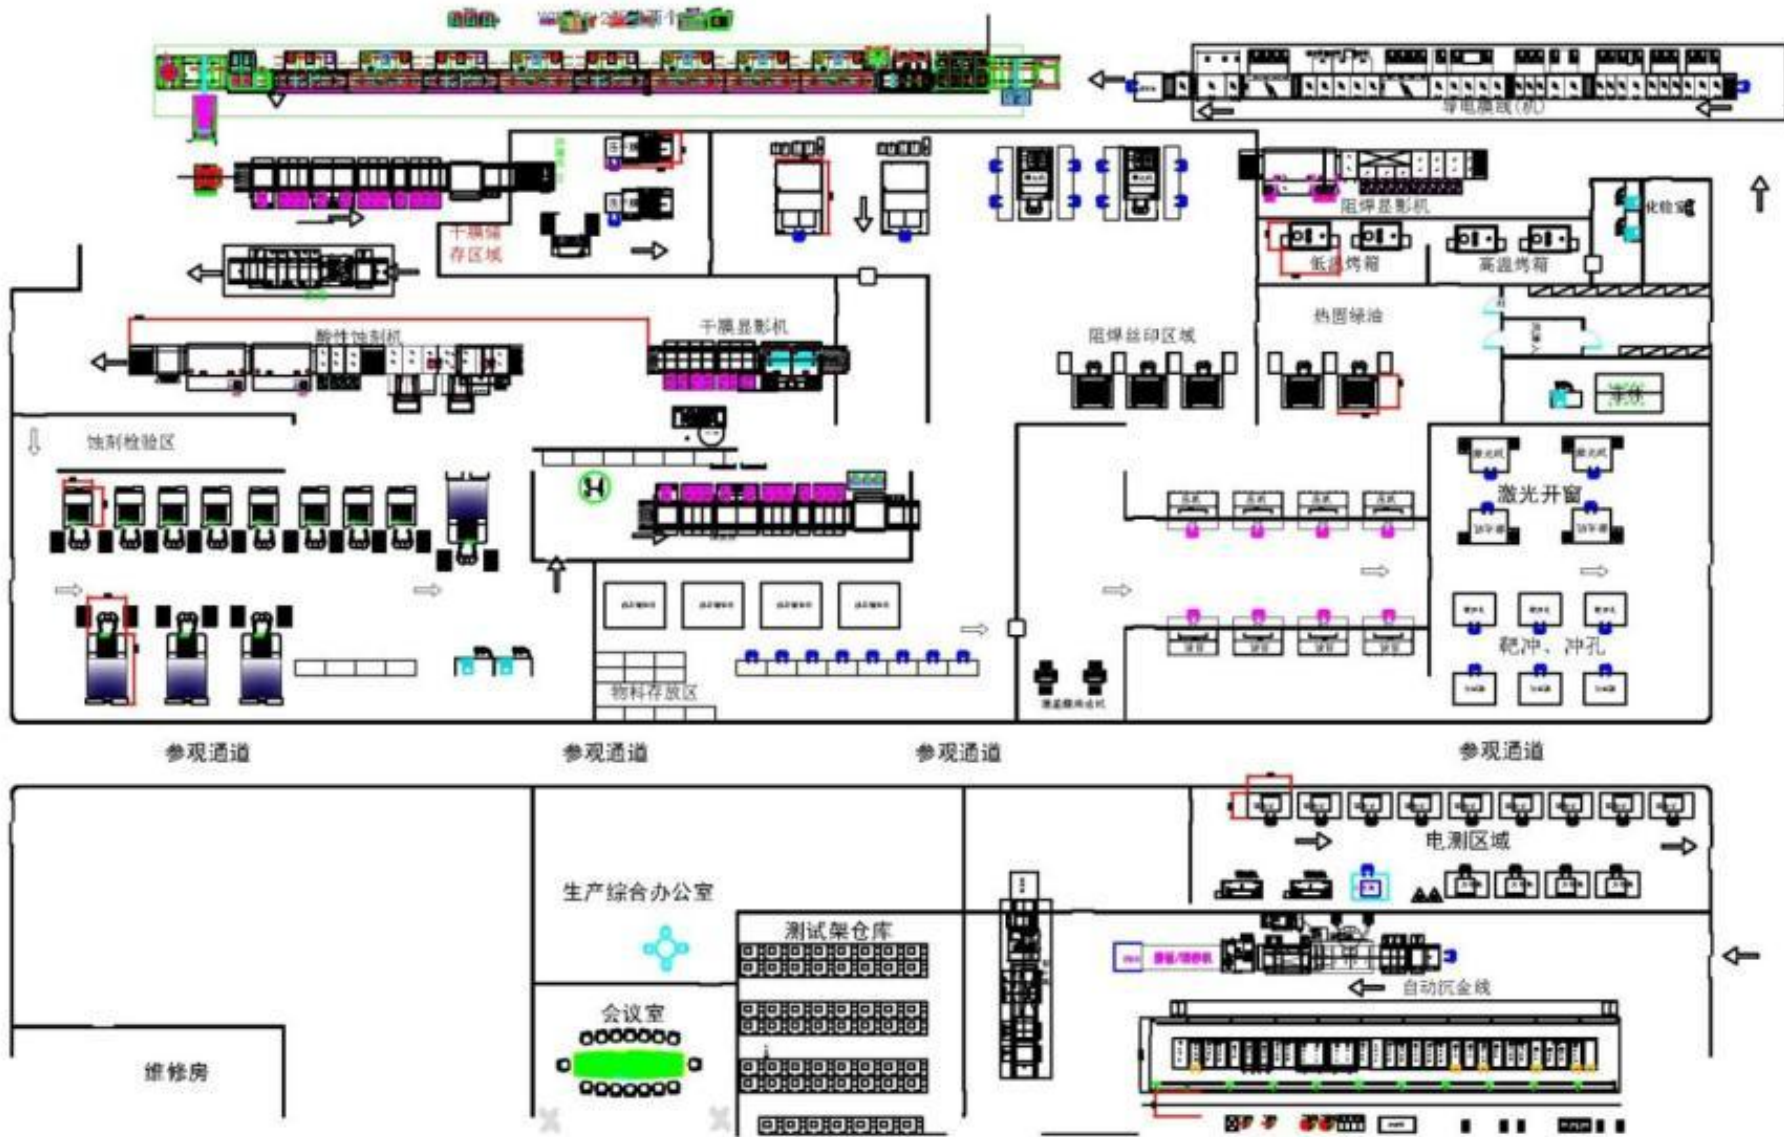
本项目二号厂房 8 楼环评阶段平面布置图
